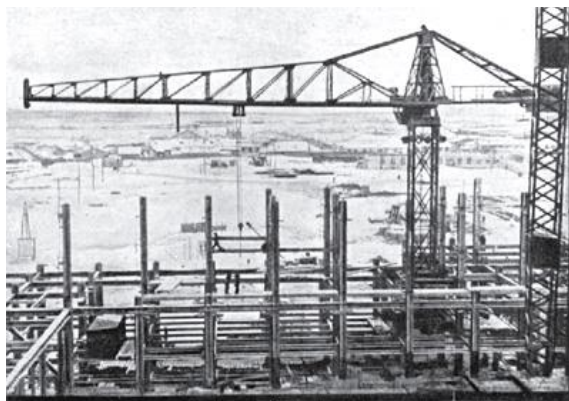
Краны УБК-5-49 на монтаже каркаса здания МГУ на Ленинских горах
